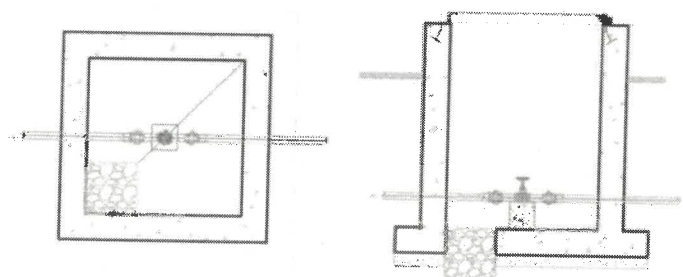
Planta y corte de válvula de control simple del sector Santa Rosa.
